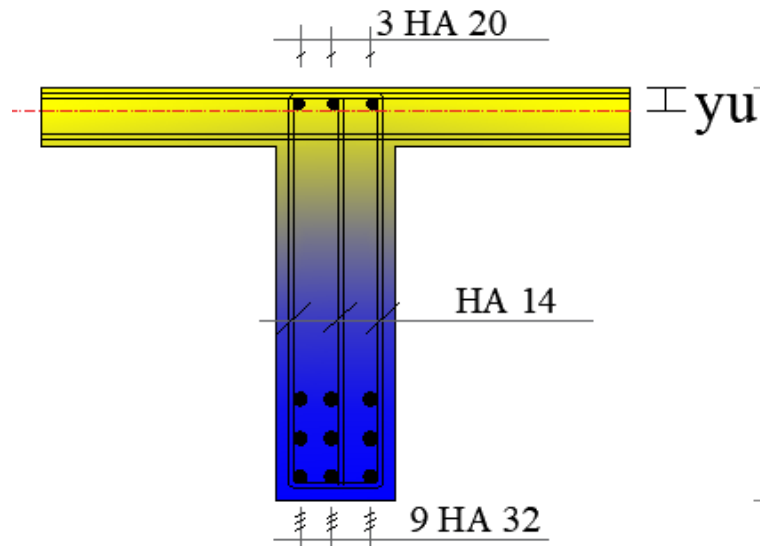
33 - Section en T de la poutre principale avec plan ferrailage (Courbon).
